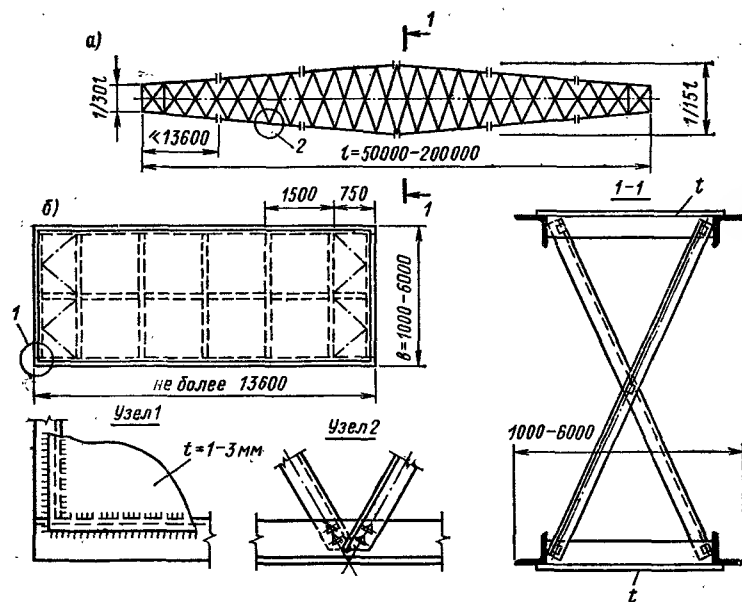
Большепролетная предварительно напряженная блочная ферма с тонколистовой обшивкой
